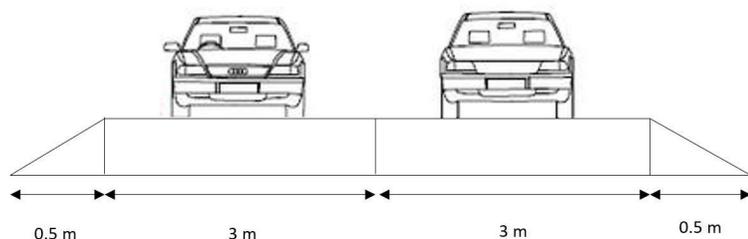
Sección transversal nueva. Fuente: Elaboración propia.
